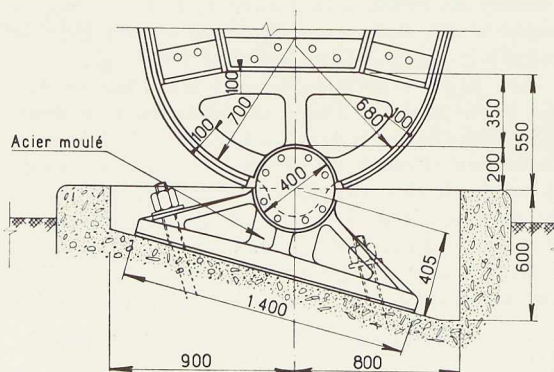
Elévation d'un appareil d'appui d'une béquille.
